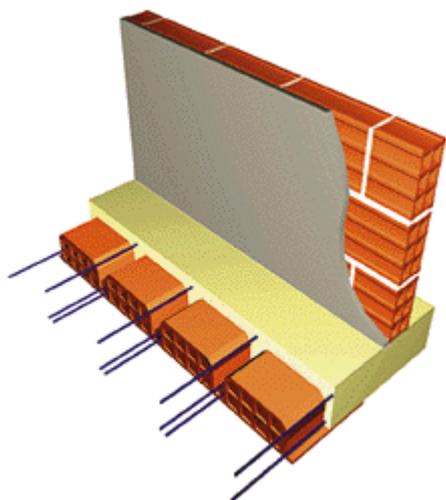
Parete divisoria disposta trasversalmente alle nervature del solaio.
